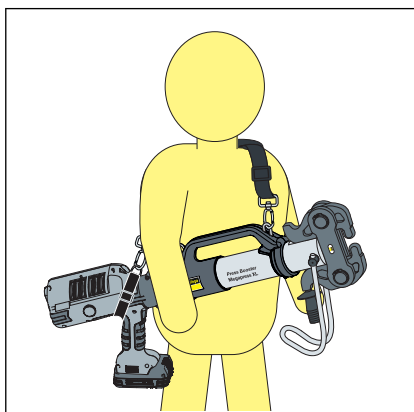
Position de la sangle de serrage sur les machines à sertir Viega
